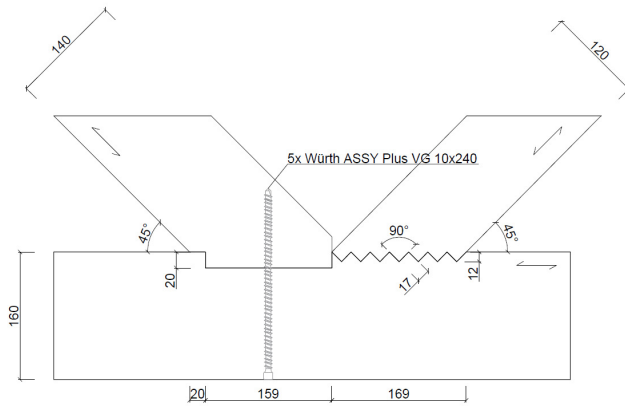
Knotendetail Träger VG-5, Maße in mm (Trägerbreite B = 160 mm)
